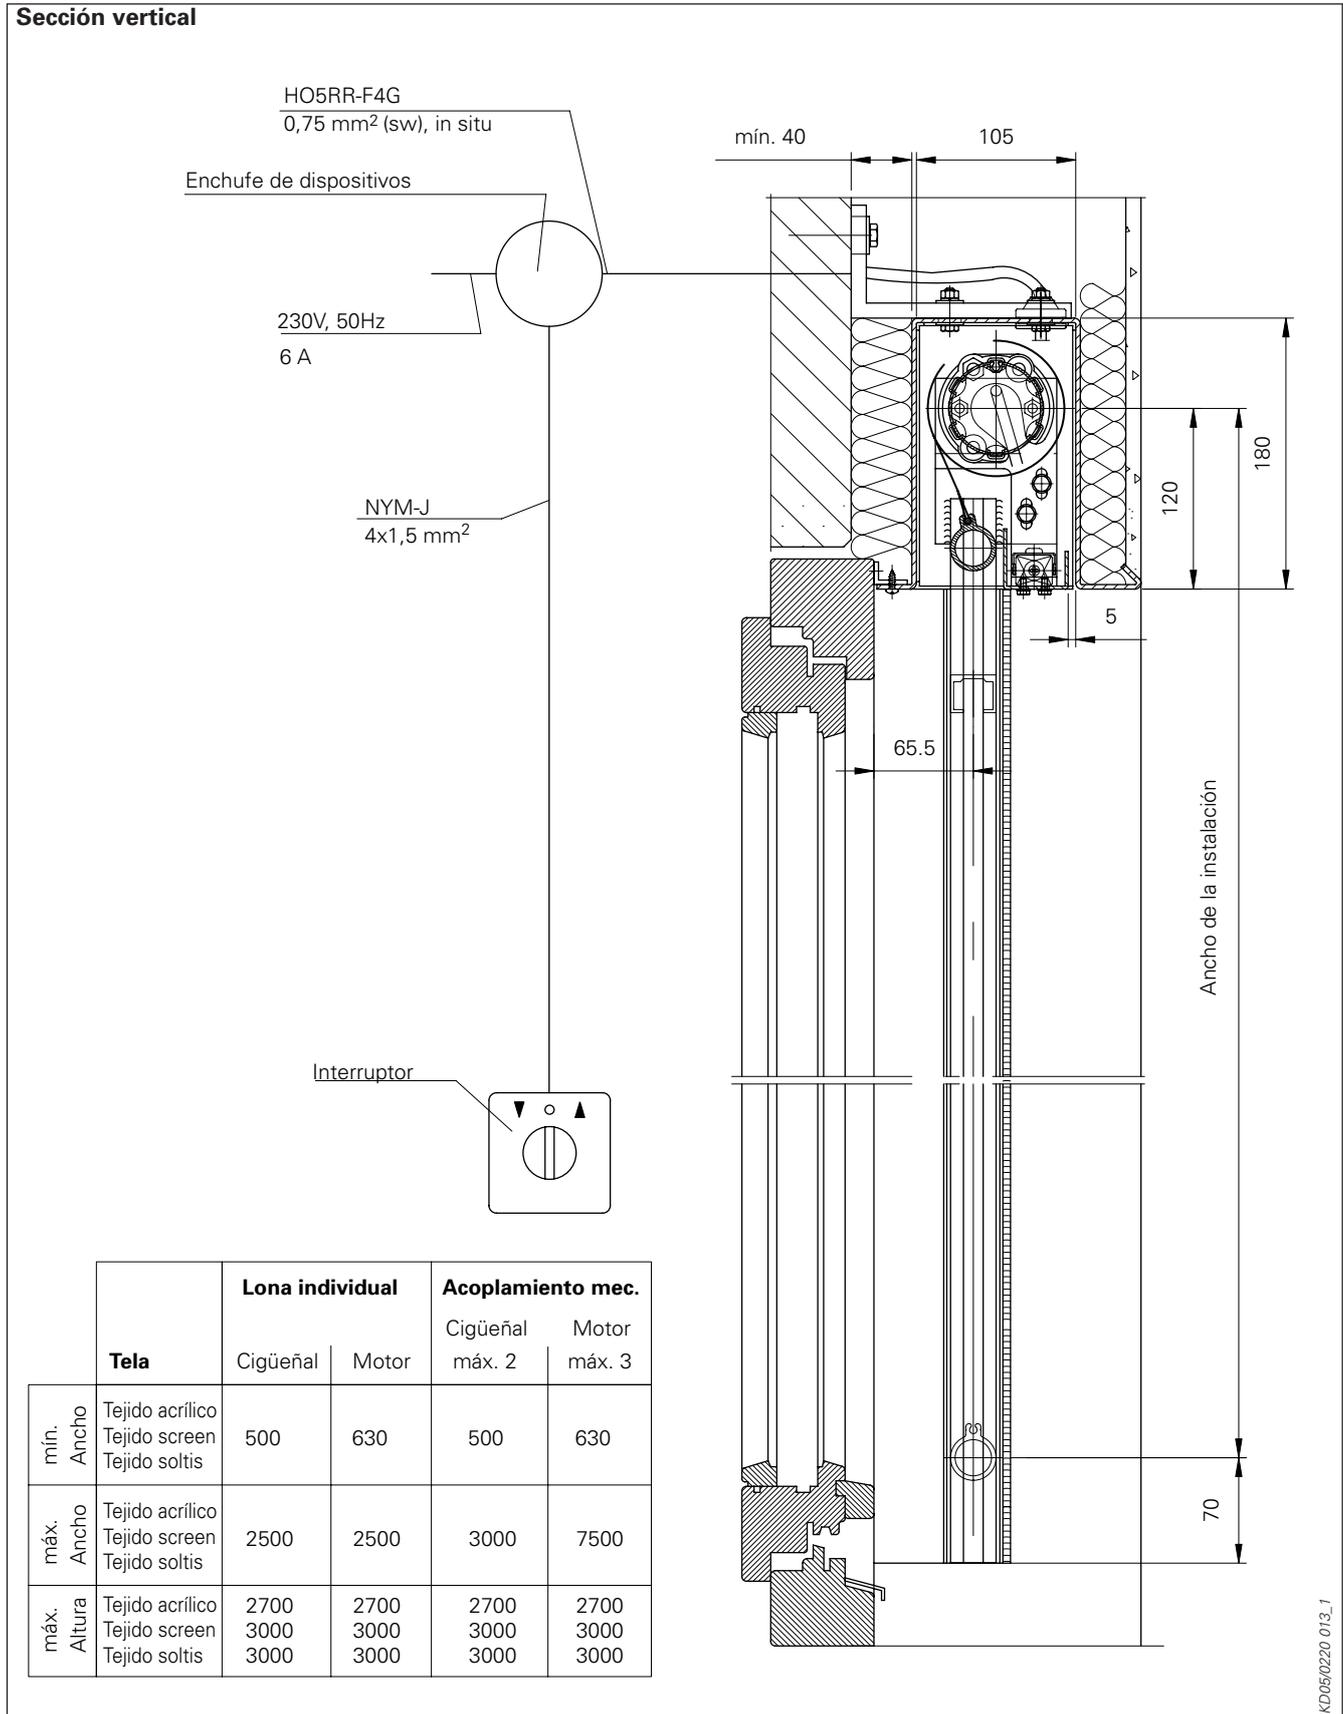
Sección vertical toldo para fachada Modelo 209 E con carril en C 25/30 empotrado en fachada con aislamiento térmico
